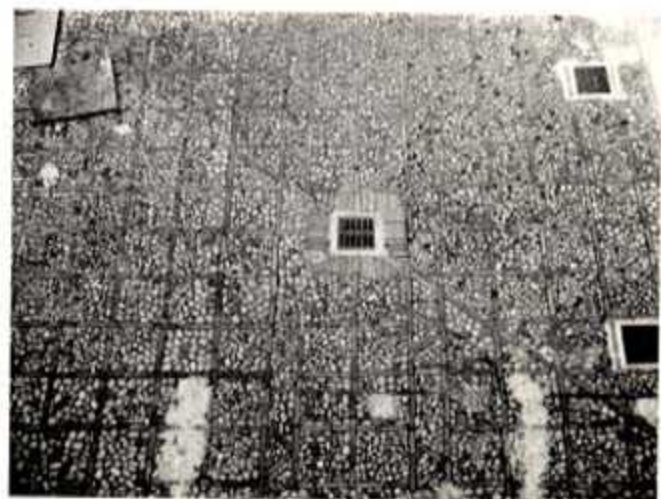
Penne, palazzo de Simone, pavimentazione dell'androne (foto C. Varragnoli 2008).
